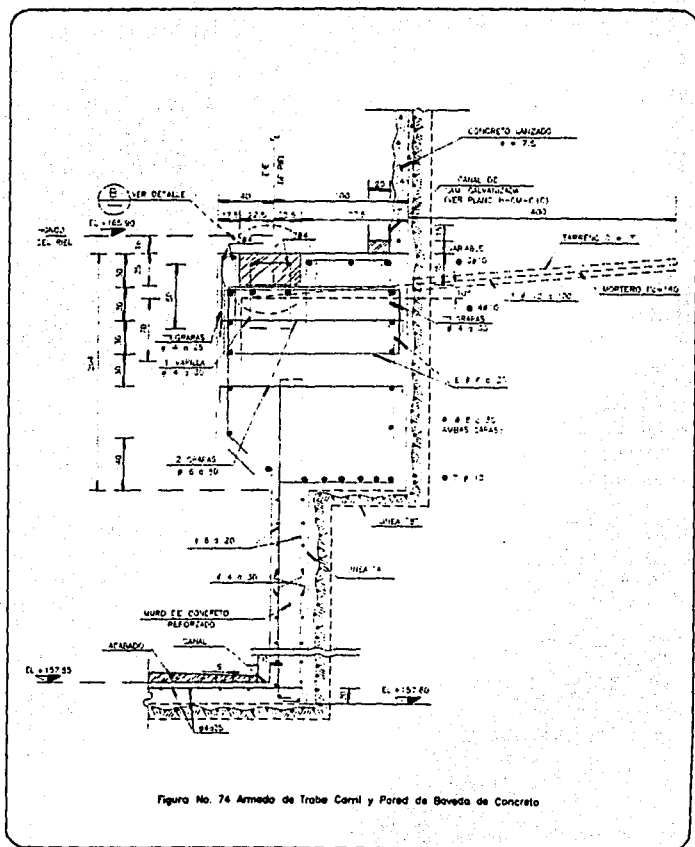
Armado de Trabe Corri y Pared de Boveda de Concreto
